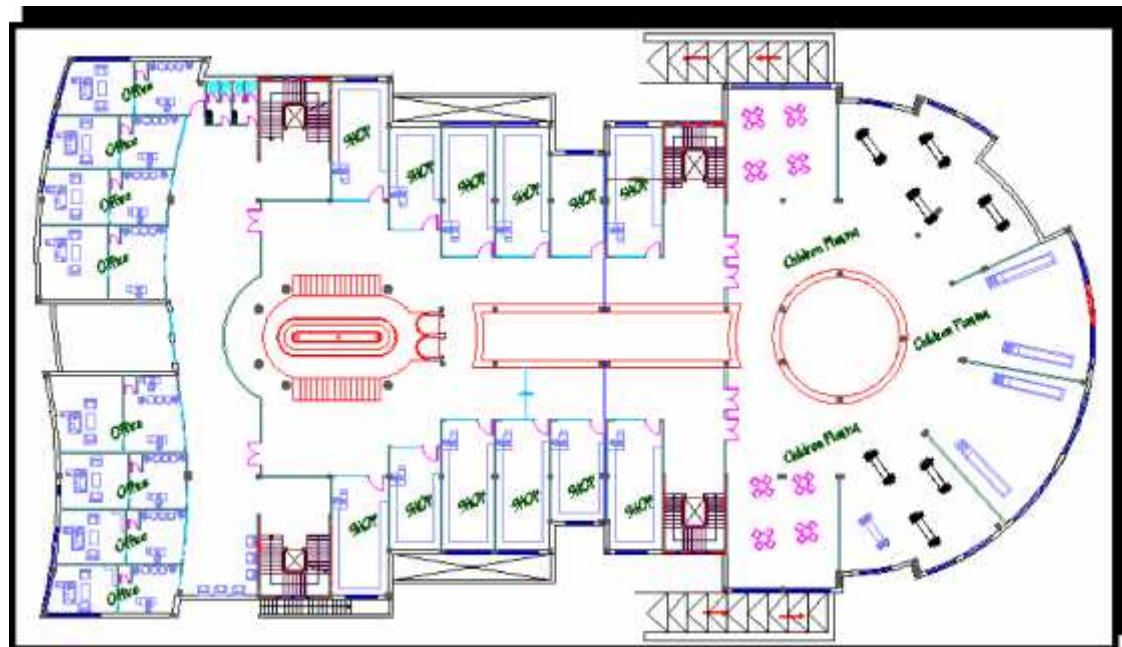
المسقط الأفقي للطابق الثاني
